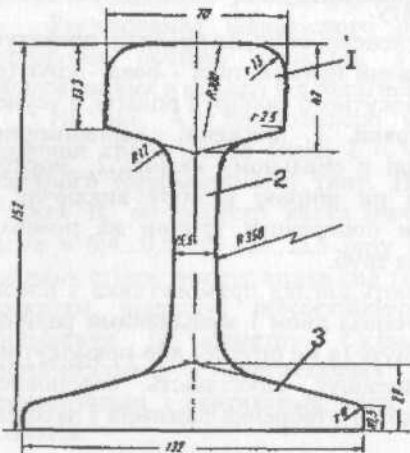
Профіль рейки P-50: 1 - головка; 2 - шийка; 3 - підшва.
